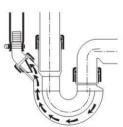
Empêchement du refoulement dans la machine à laver le linge ou la vaisselle par le double corps
